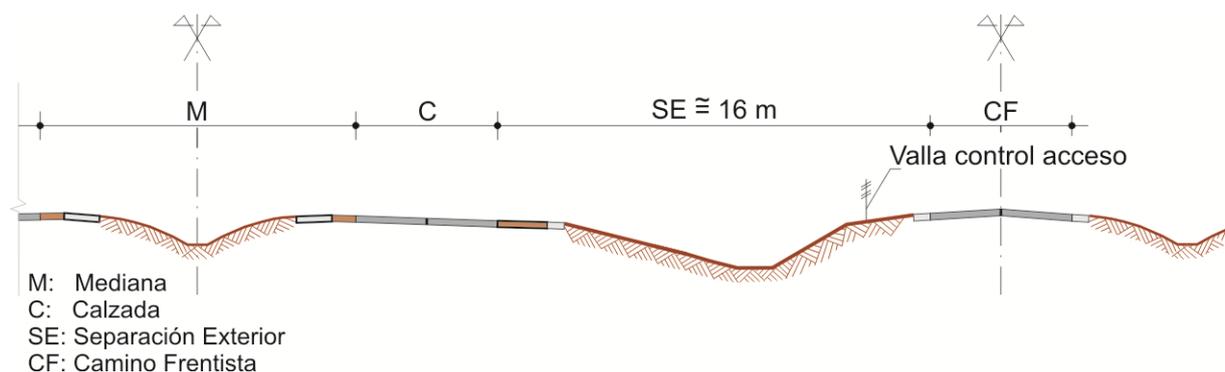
Sección transversal típica de separación-exterior en zona rural
